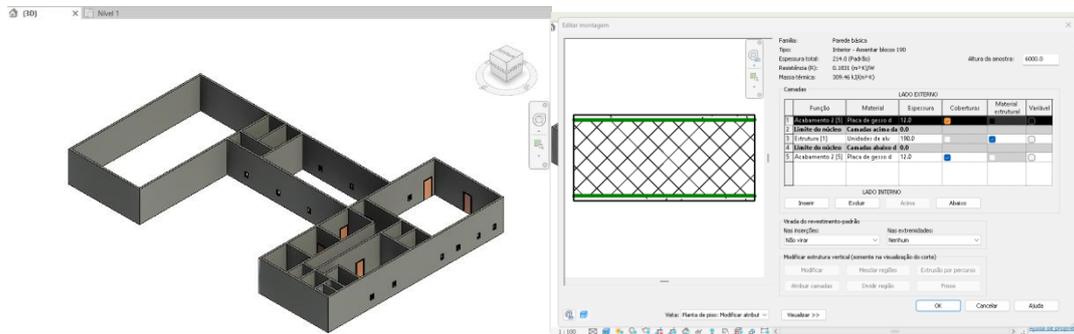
Modelagem executada em 3D e detalhamento das paredes.
